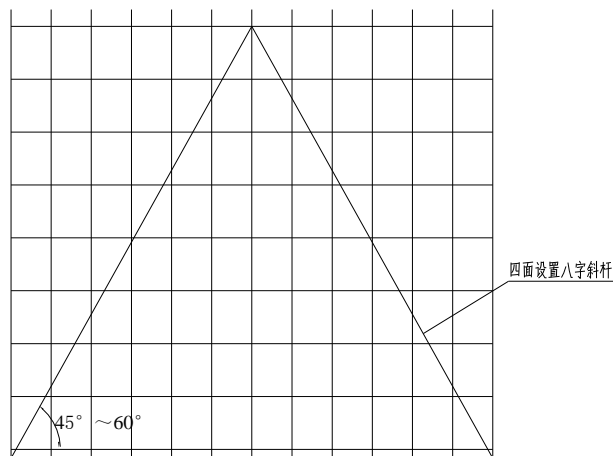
碗扣式模板支架八字斜杆布置立面示意图
